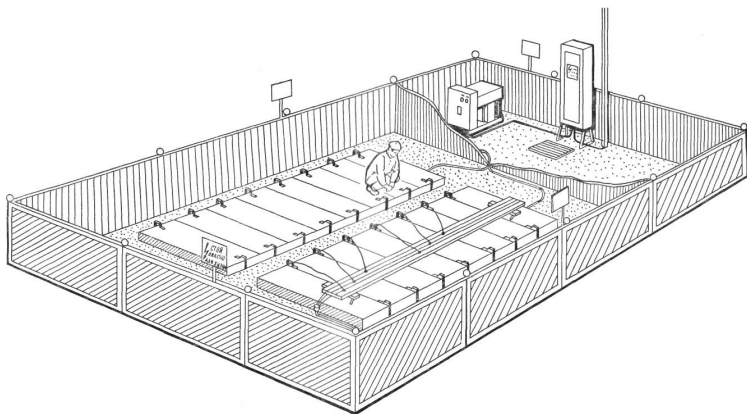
Схема електропрогрівання бетонних та залізобетонних виробів
